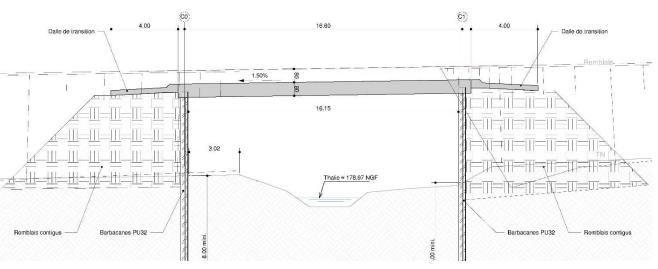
Coupe longitudinale de l'ouvrage d'art de la Thalie (Source : Setec, 2020)
